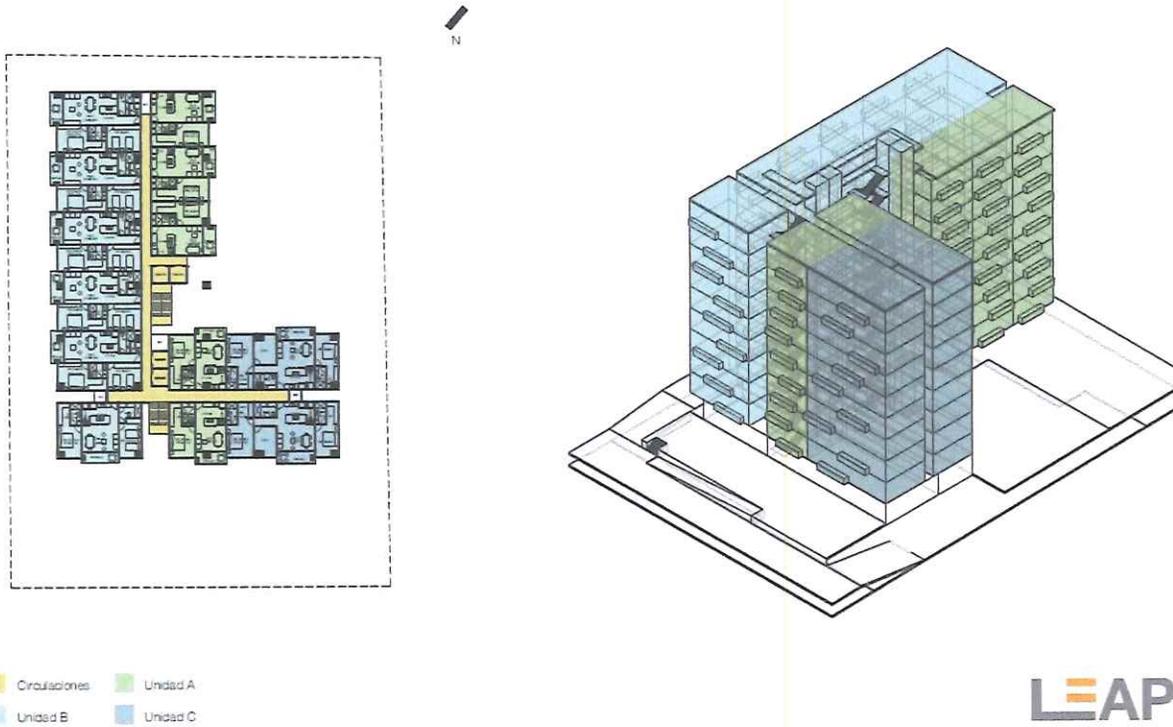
Ilustración de la distribución del nivel 2 al 10, Fuente: Plano Arquitectónico.
